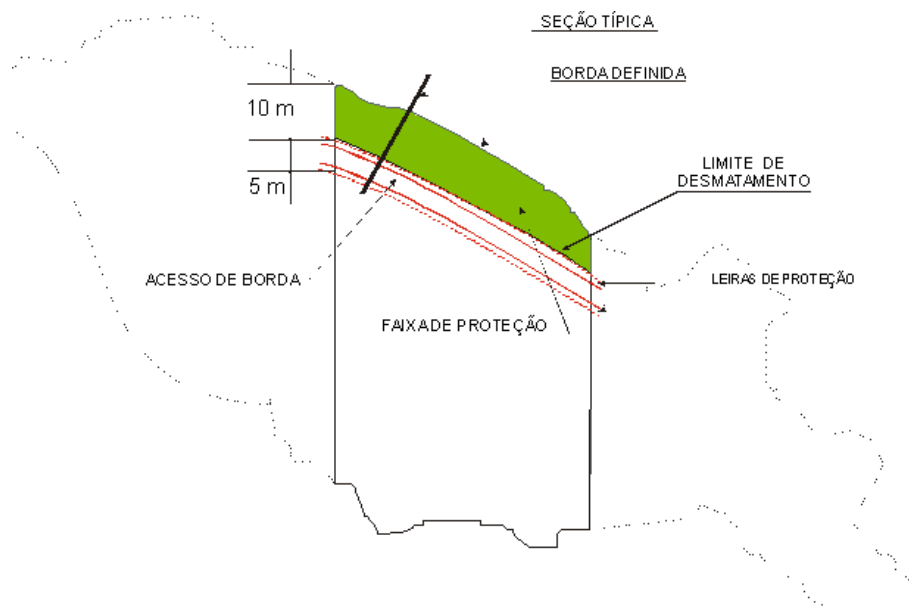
Vista em planta da faixa de proteção de borda do platô.
